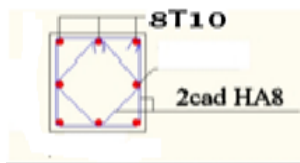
Schéma de ferrailage de la poutre palière.
